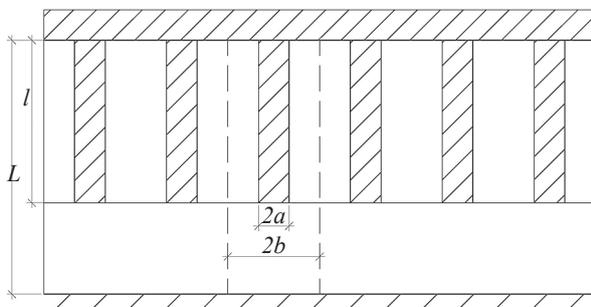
Схема для выделения расчетной ячейки свайно-плитного фундамента
